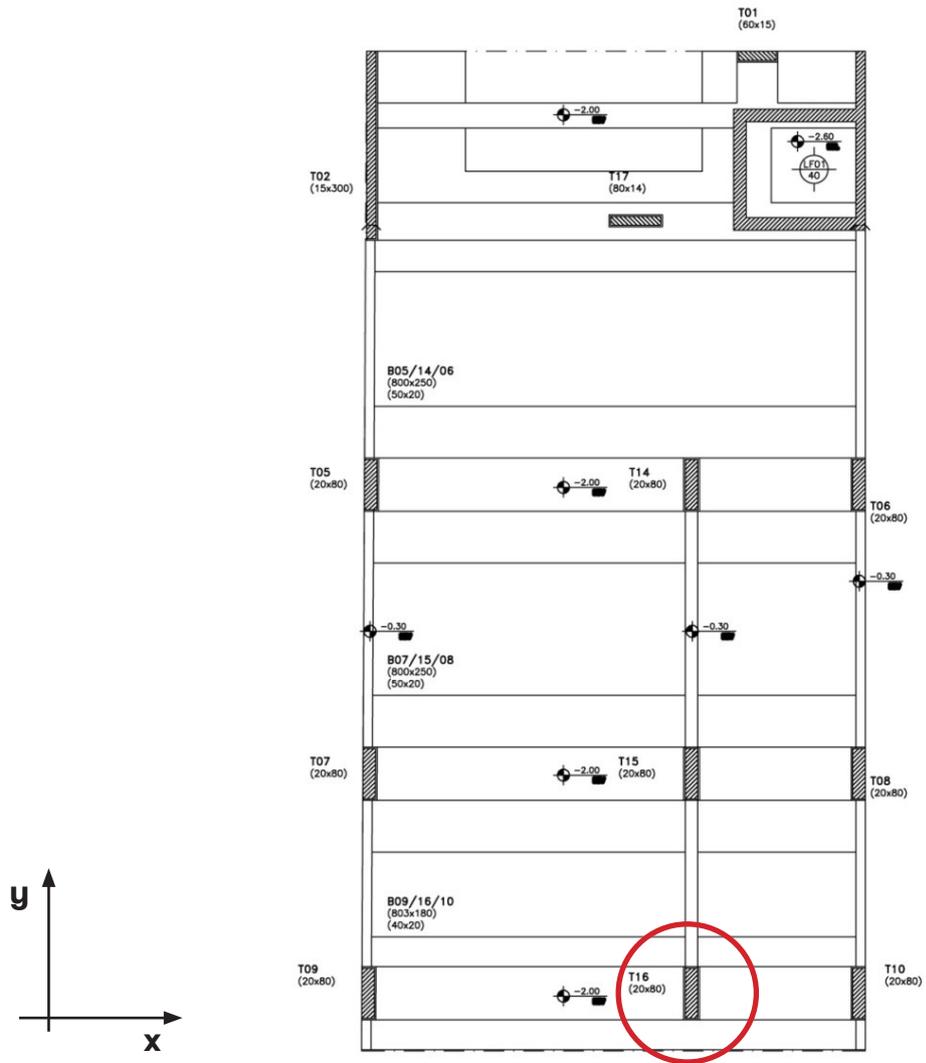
Planta Estructura de Fundaciones y direcciones de análisis. Fuente: Estudio de arquitectura A3 Digital
